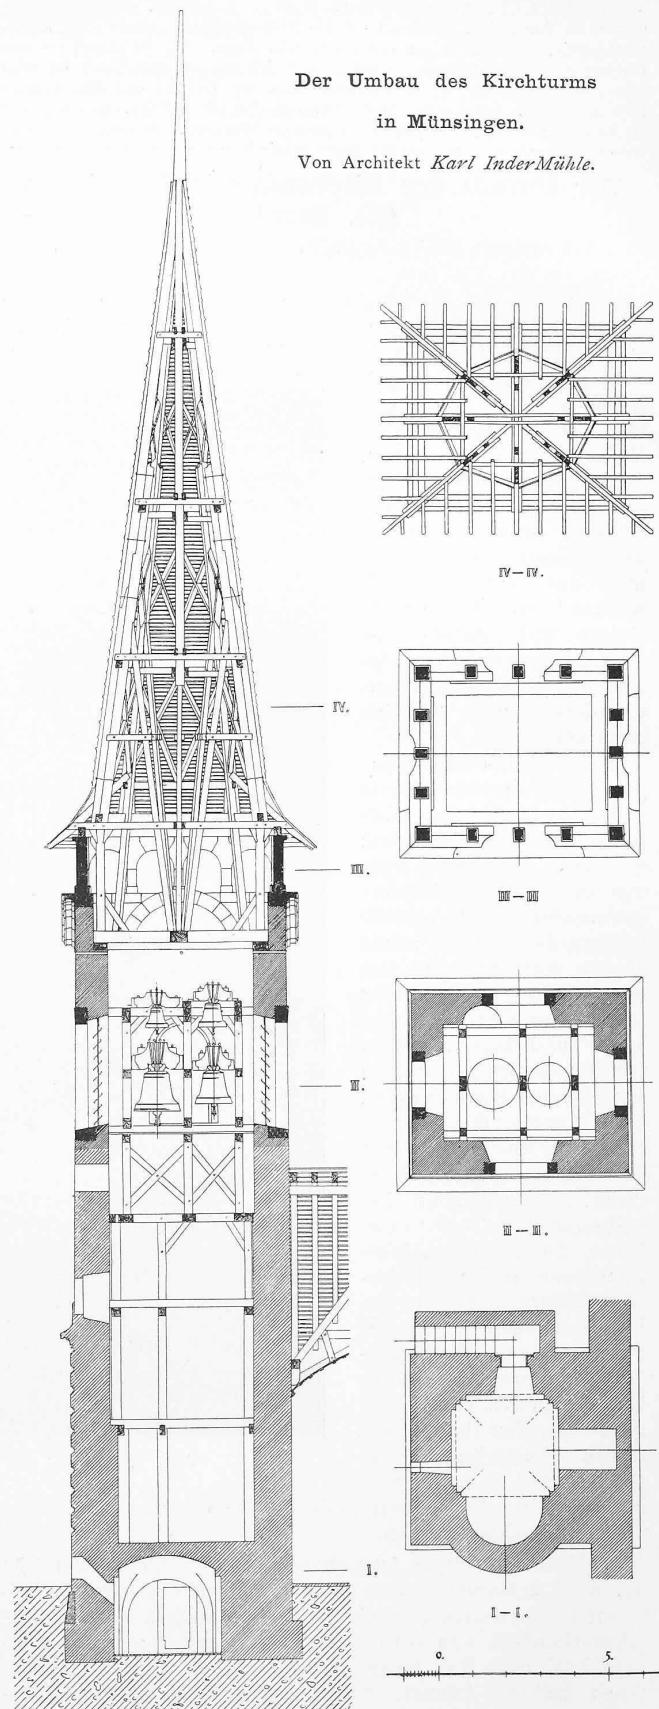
Schnitt und Grundrisse. — Masstab 1 : 200.
